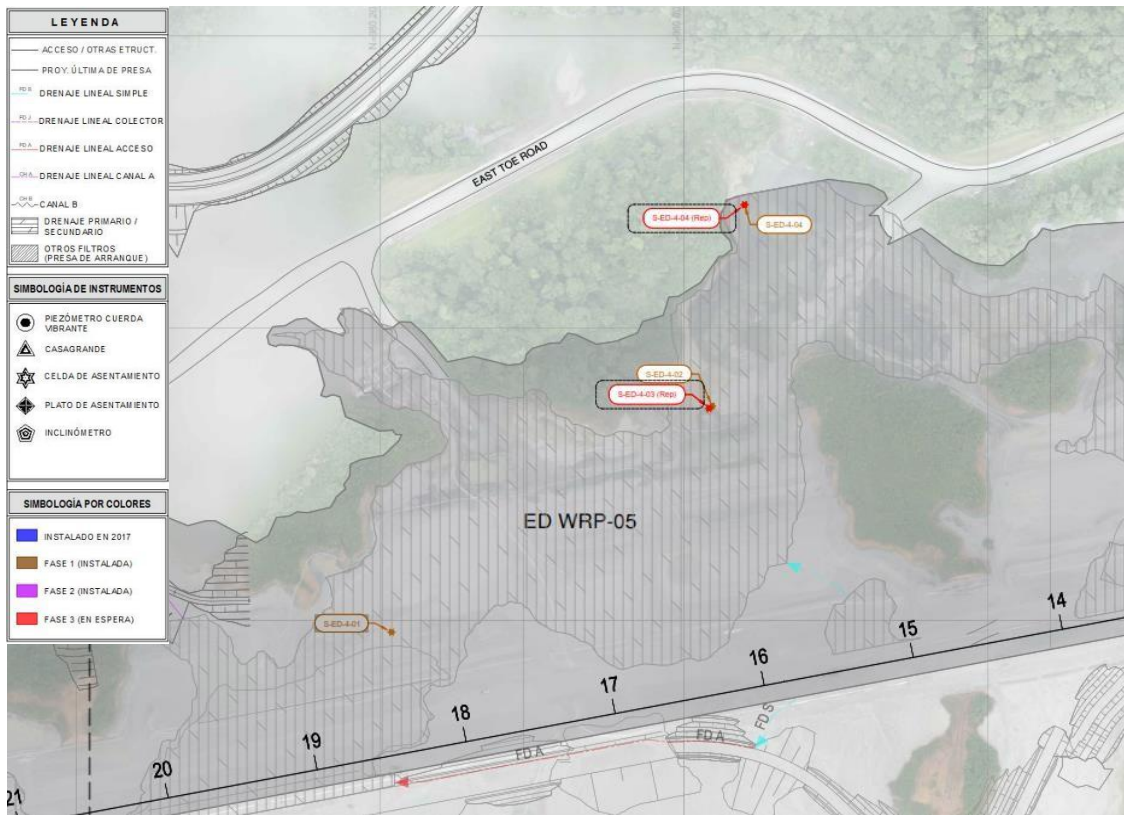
Vista de Planta Presa Este - Plataforma 5 (ED-WRP5) - Instrumentos de celdas de asentamiento
